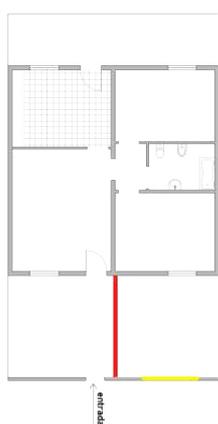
Planta esquemática com registo da apropriação destacada do bairro CAR de Camarate
